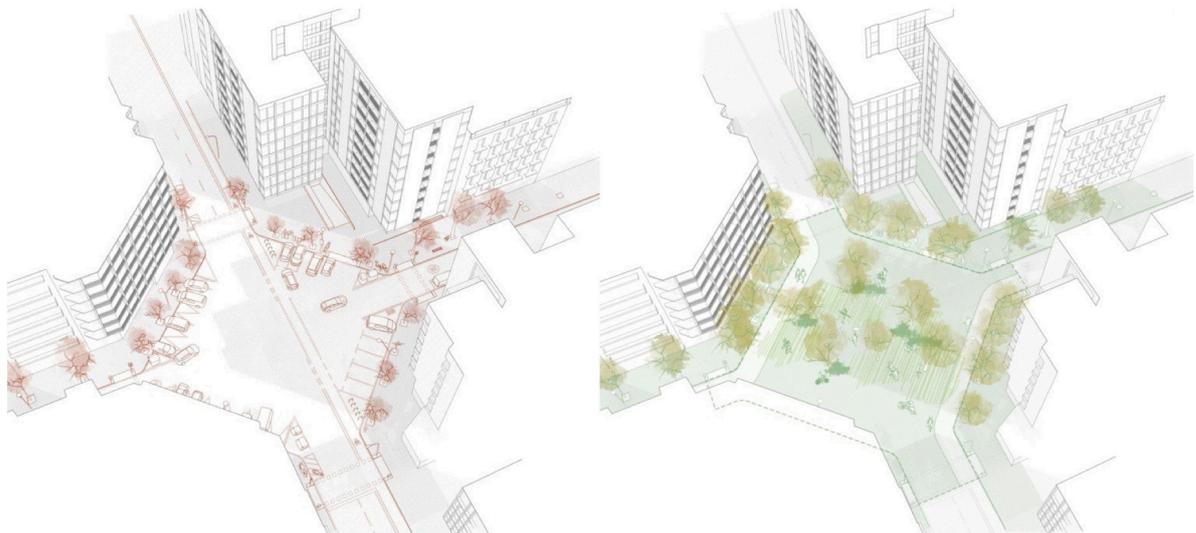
Vista assonometrica progettuale ipotetica delle Superilla.
